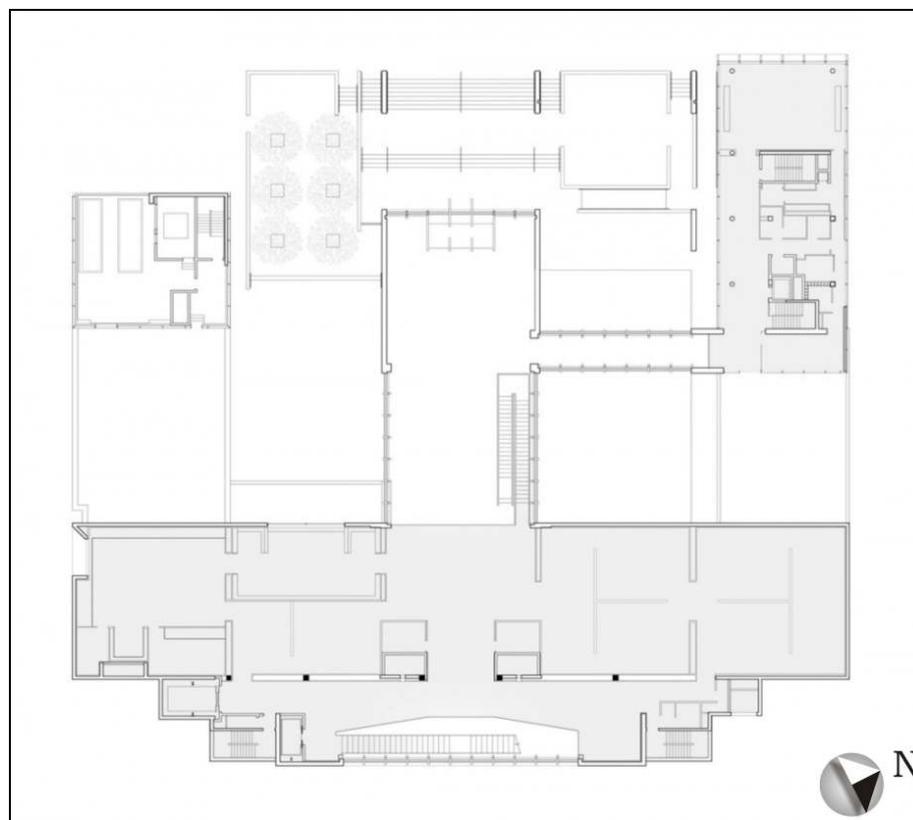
Planta baixa do segundo pavimento (BASULTO, 2009).
